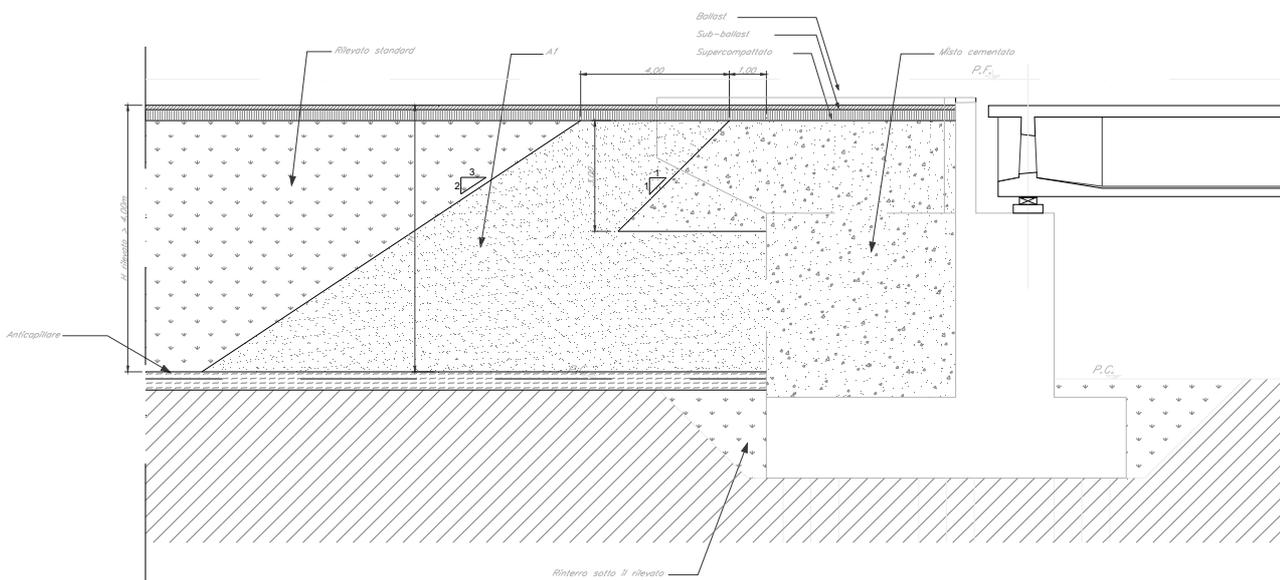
Zona di transizione rilevato – spalla viadotto/ponte con $H > 4,00$ m
